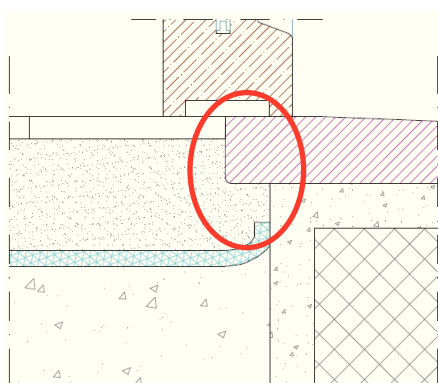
esempio posa errata del giunto portafinestra – solaio, con il contatto rigido tra massetto, pavimentazione e soglia
